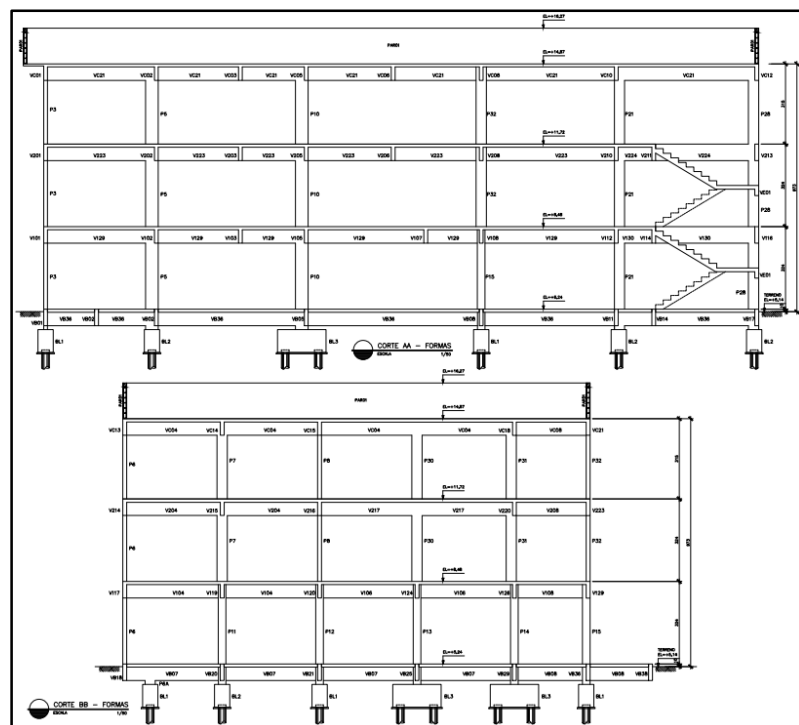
Corte estrutural Prédio Escolar – 2ª Etapa
